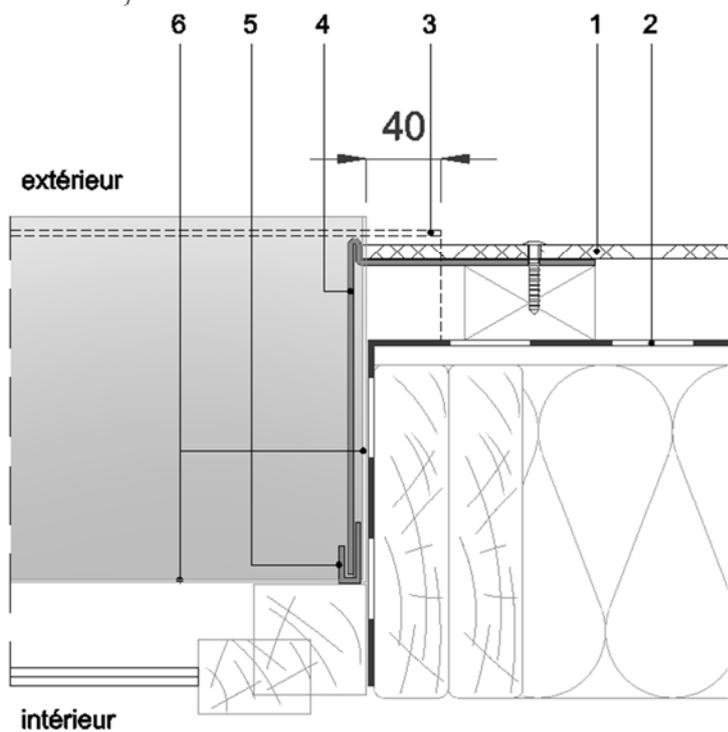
Coupe sur linteau de baie – Pose sur COB
